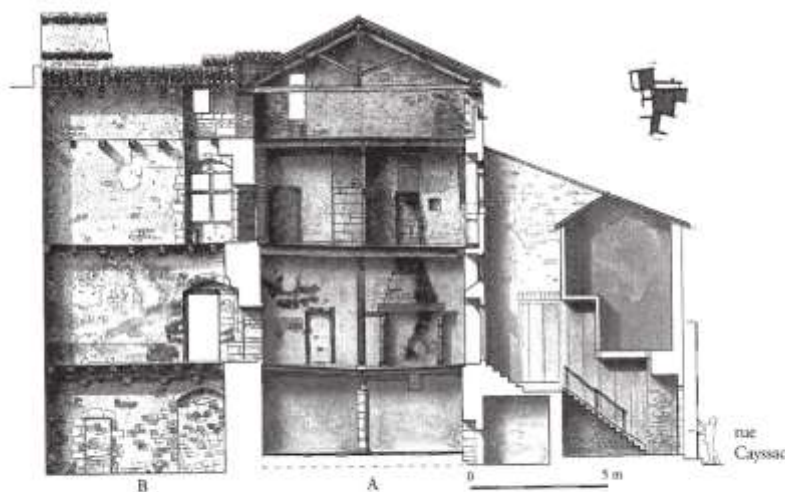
Saint-Antonin, 6, rue Cayssac, coupe sur B et A, vers l'est (dessin M. Barchès) : la rareté de l'espace libre oblige à regrouper les fenêtres géminées de B sur le pan de mur dans l'axe de la ruelle, près des latrines. La cheminée, les planchers, cloisons et plafonds, et les décors peints sont authentiques. Ceux de B figurent des faux-marbres particulièrement riches.
